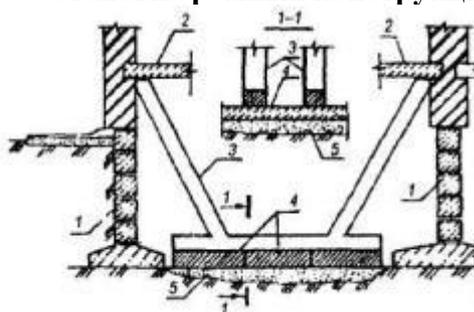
1 - усиливаемые фундаменты; 2 - плита перекрытия; 3 - опорная рамная конструкция из железобетона или металла; 4 - дополнительный фундамент из сборных плит; 5 - зона уплотненного грунта.
